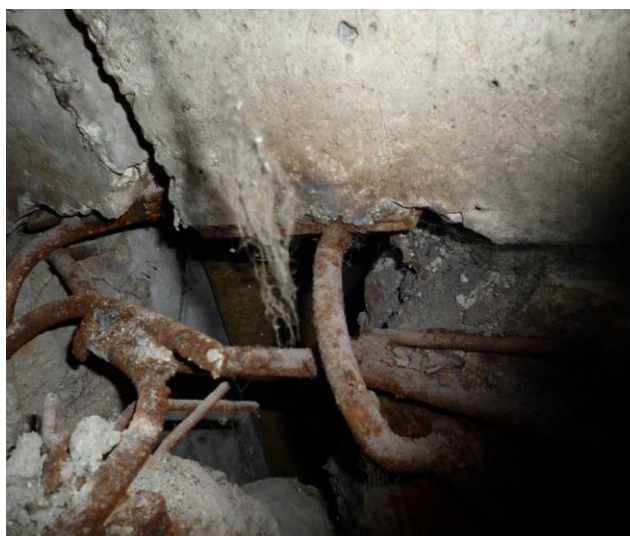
Типичное состояние узловых соединений на обследуемой крыше
